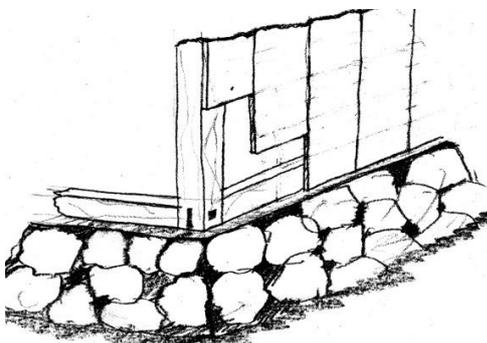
Tipe pondasi rumah bajo tipe 3.
